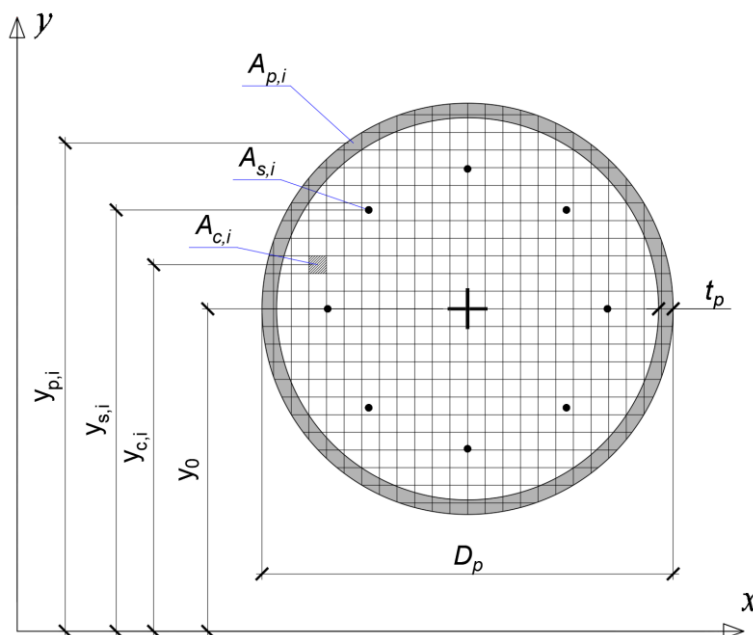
Расчетное поперечное сечение изгибаемого трубобетонного элемента
